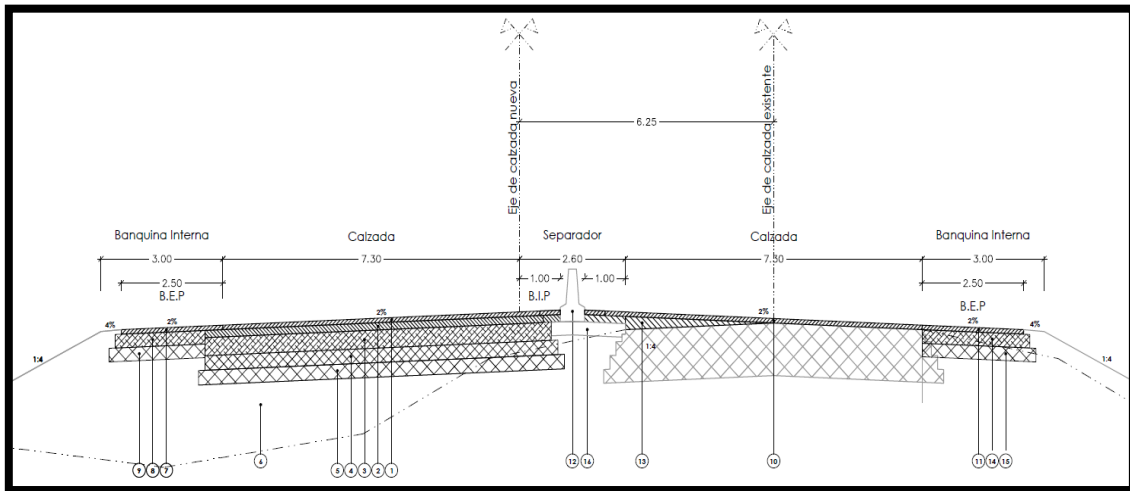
Perfil tipo de pavimento para la Sección 2, PR 30+800 a 32+950.42.
